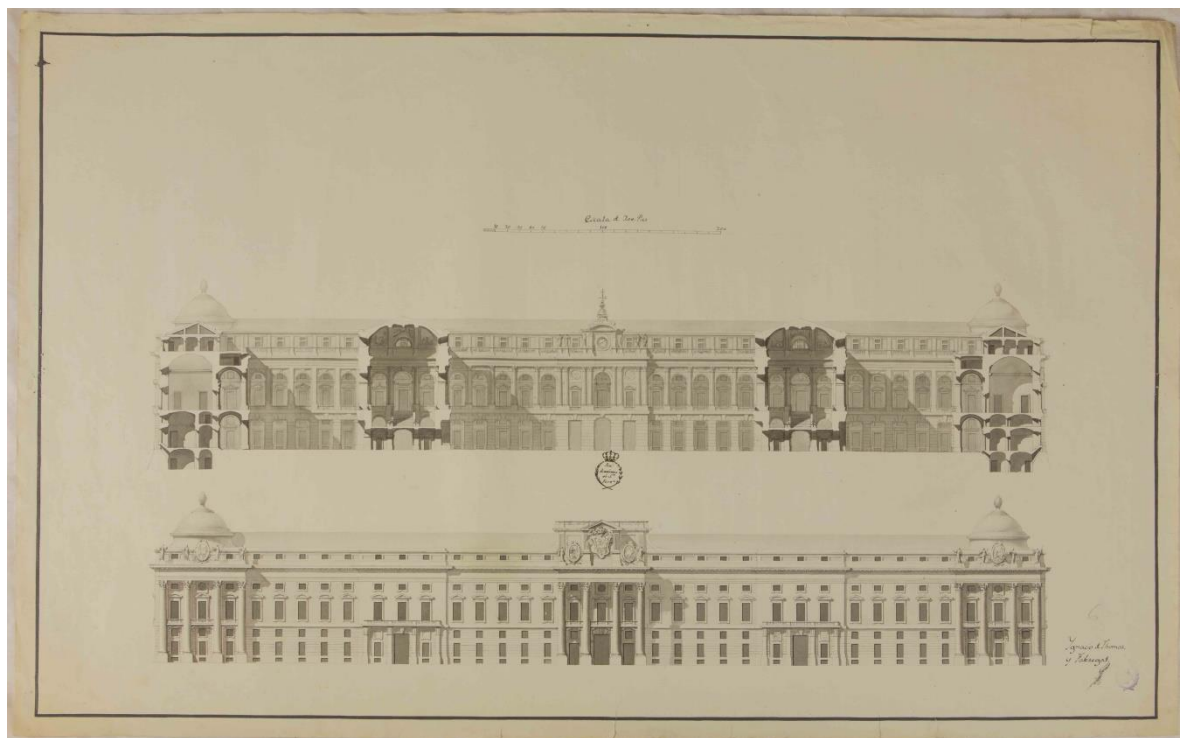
Dibujo A-259: Alzado de la fachada principal y sección, Archivo R.A.B.A.S.F.
